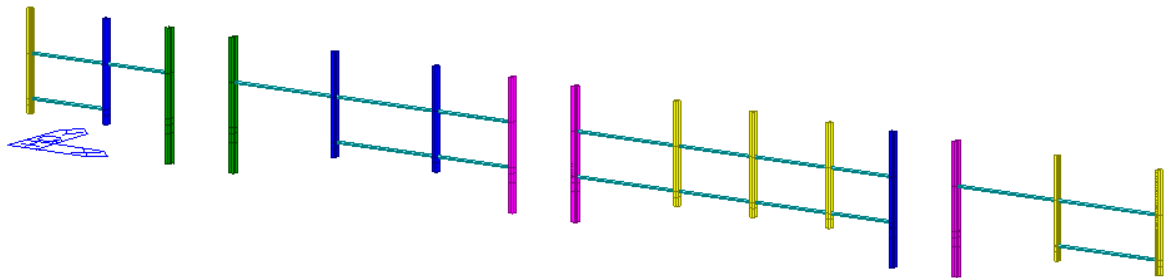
Vista della barriera 4.50m - tratto ovest da M01 a M15
